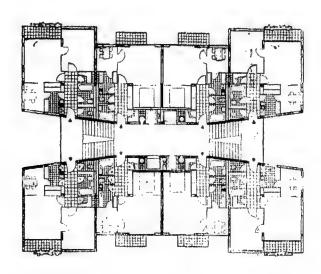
١٠ - ٢ : مسقط الدور المتكرر .
